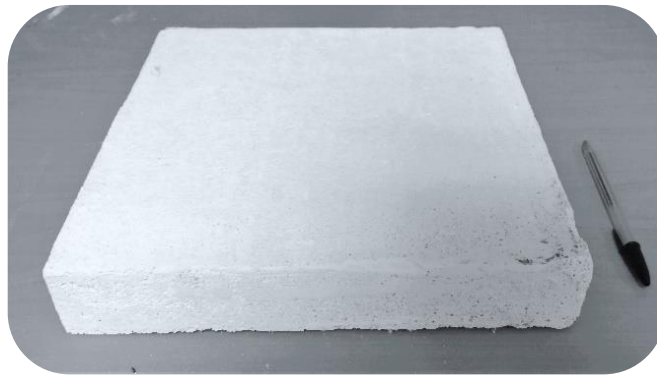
Eprouvette en mousse minérale de dimensions 30×30×05 cm
